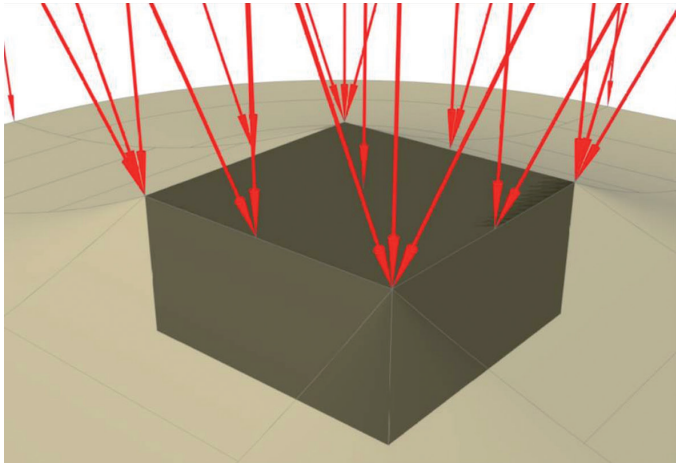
Ecken und Kanten einer baulichen Anlage sind besonders gefährdet.
